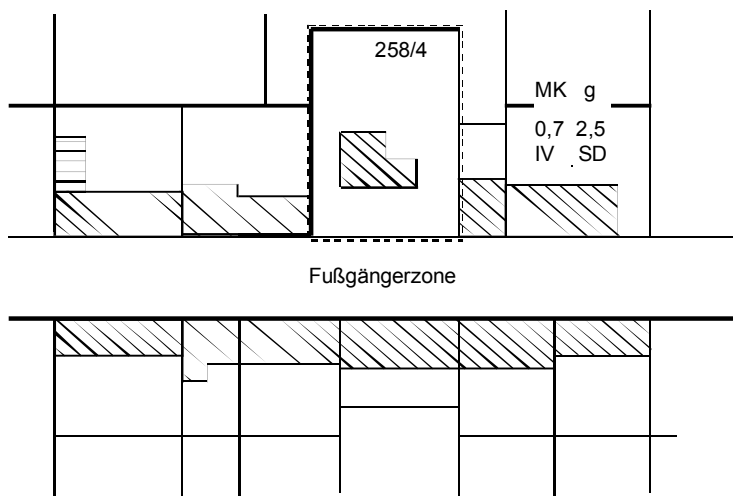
Lageplan des minderausgenutzten Grundstücks
